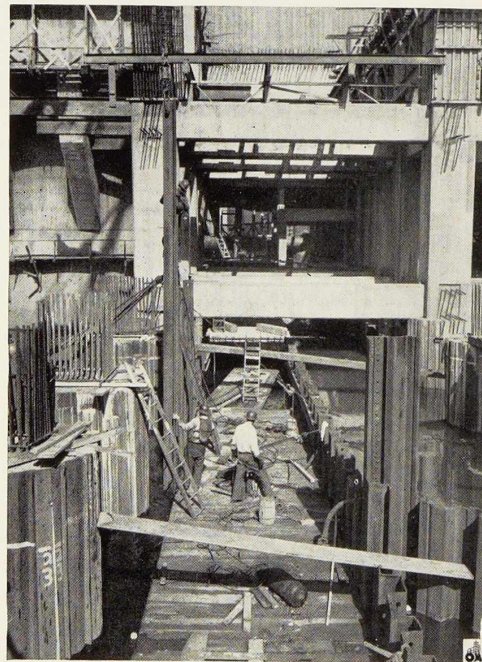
Colonnes en béton armé montées sur caissons en palplanches plates.
